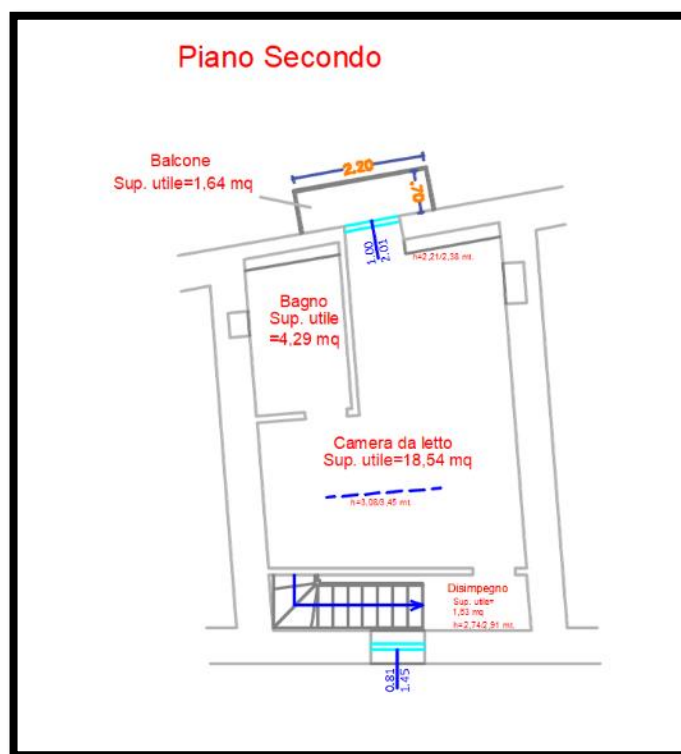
Rilievo piano secondo dell'immobile identificato con la particella 688 sub 1
